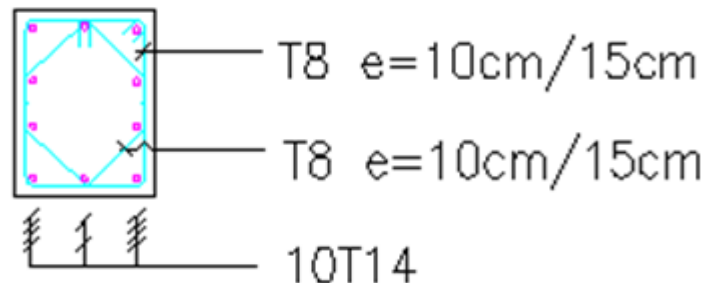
Schéma de ferrailage des poteaux RDC+ ETAGE
